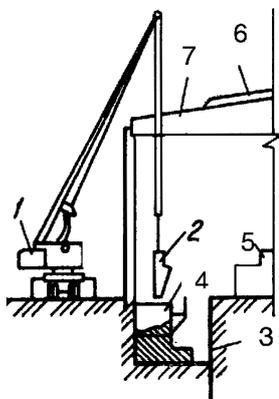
Подача бетонной смеси стреловым краном через проем в покрытии: 1 – стреловой кран; 2 – поворотный бункер; 3 – шпунтовое ограждение; 4 – блочно-переставная опалубка; 5 – существующее оборудование; 6 – плиты покрытия; 7 – проем в покрытии
